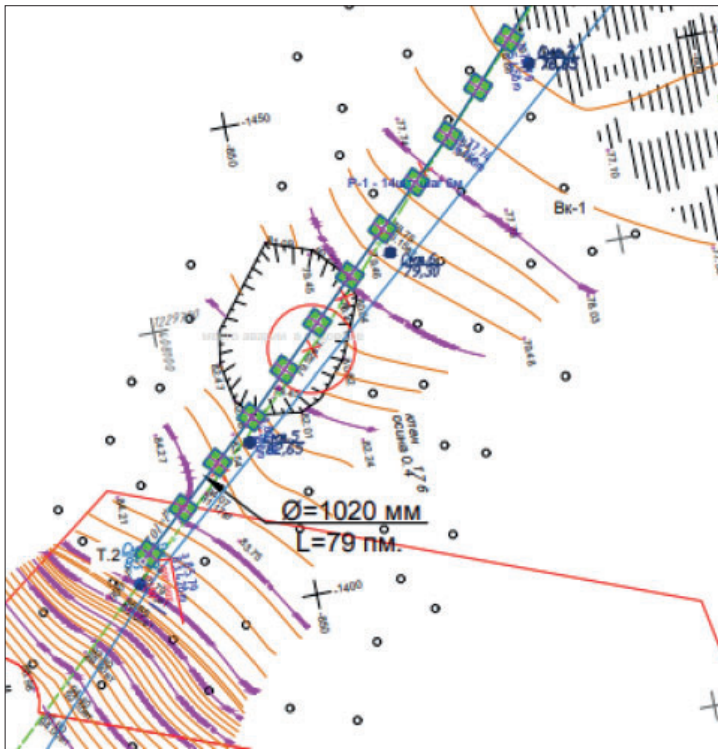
План монолитных железобетонных ростверков под напорный трубопровод $d=1020$ мм
